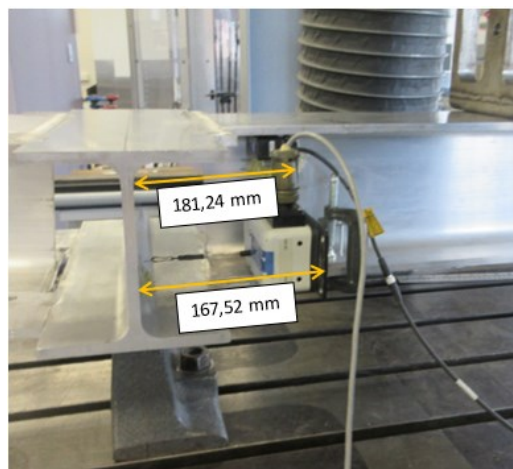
Emplacement de capteur à câble et capteur de déplacement laser
